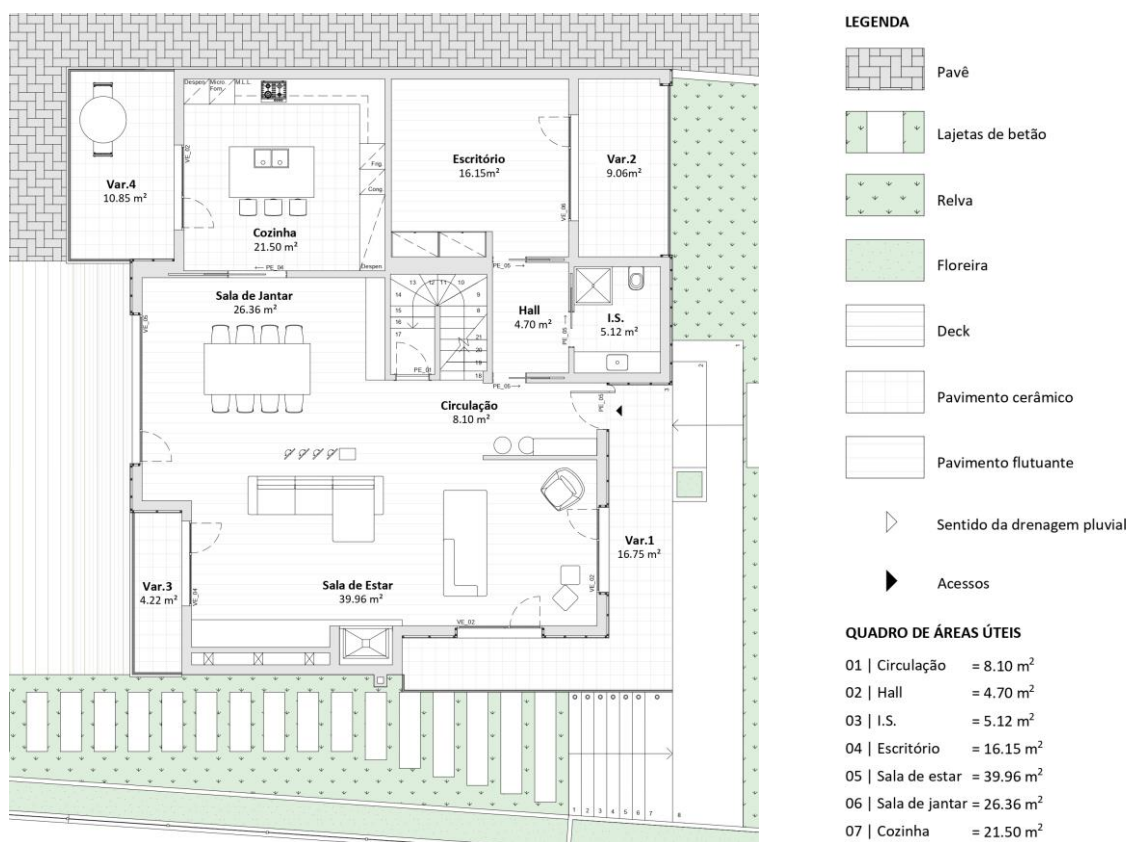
Proposto - Planta do piso 0 (LIC_R00). Fonte: Garq / Desenvolvimento: Autora.
